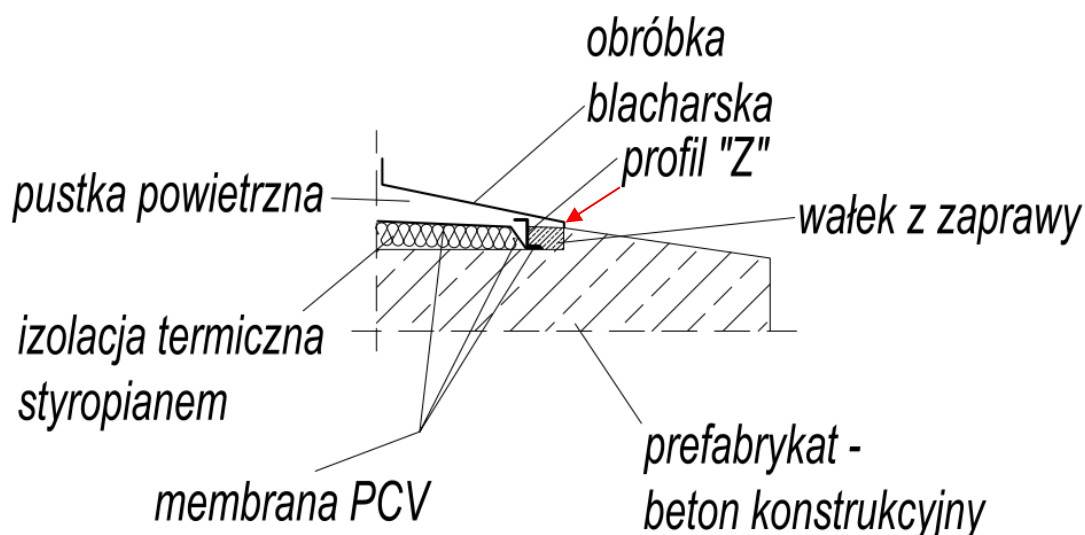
Detal rozwiązania architektonicznego styku elewacji z prefabrykatem. Miejsce odkrywki zaznaczono czerwoną strzałką [4.9].
